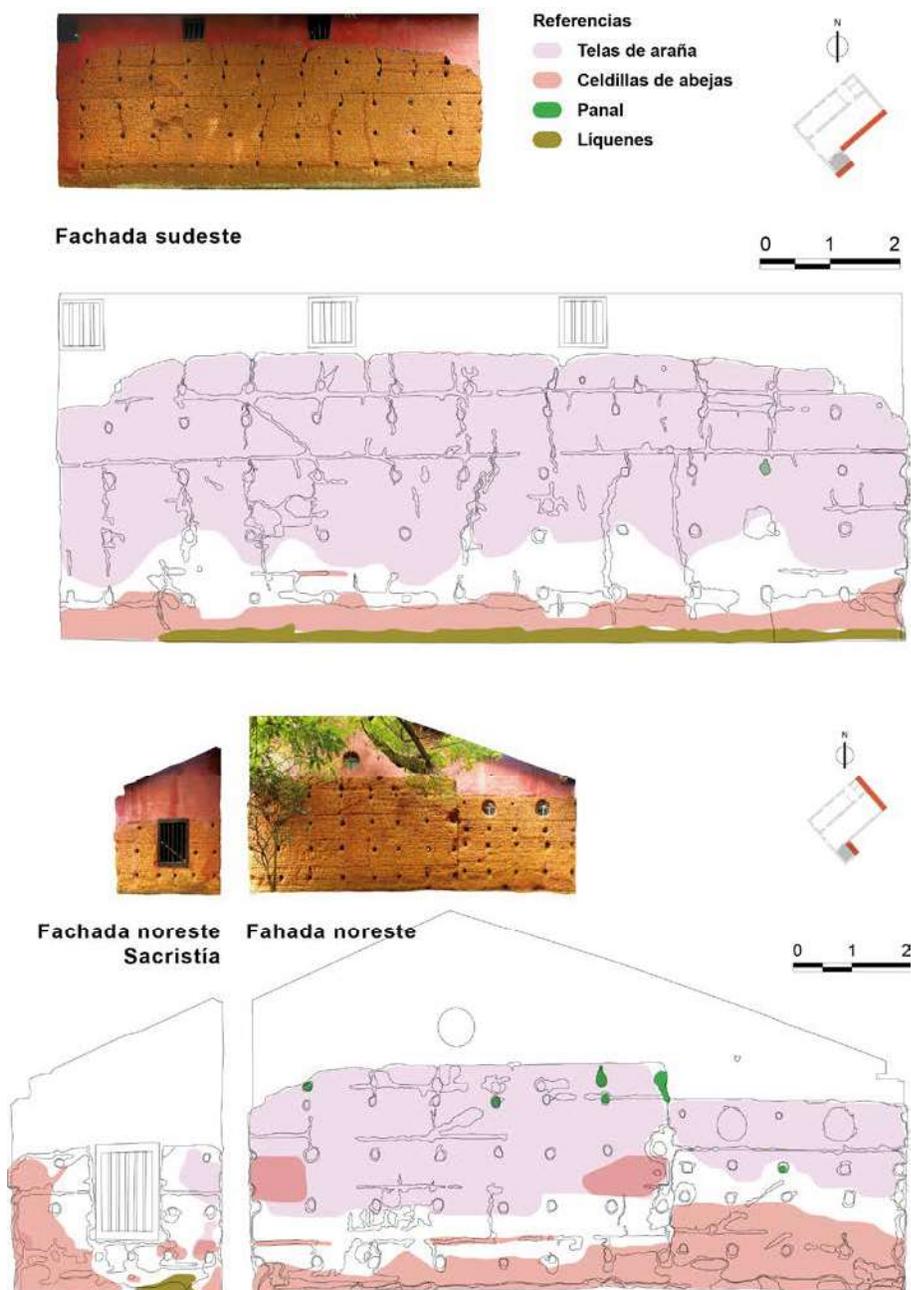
Registro de biodeterioros en las fachadas de *Capela do Morumbi*.
